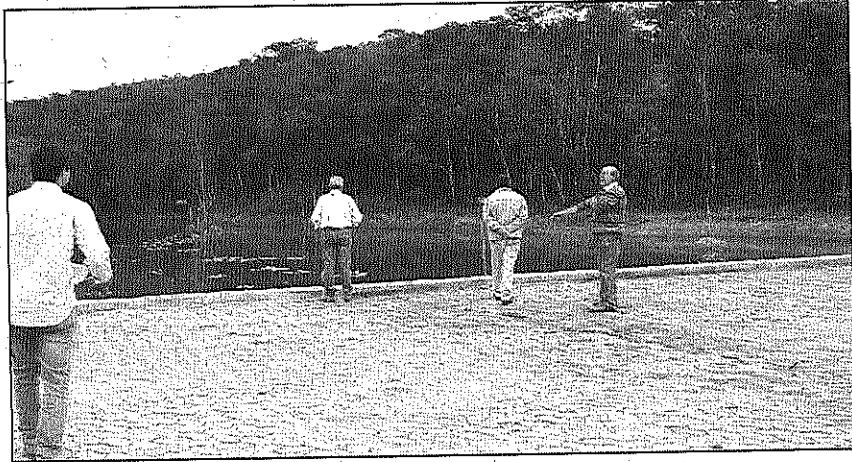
Construção de dispositivos de drenagem e plantio de mudas às margens do brejo.
